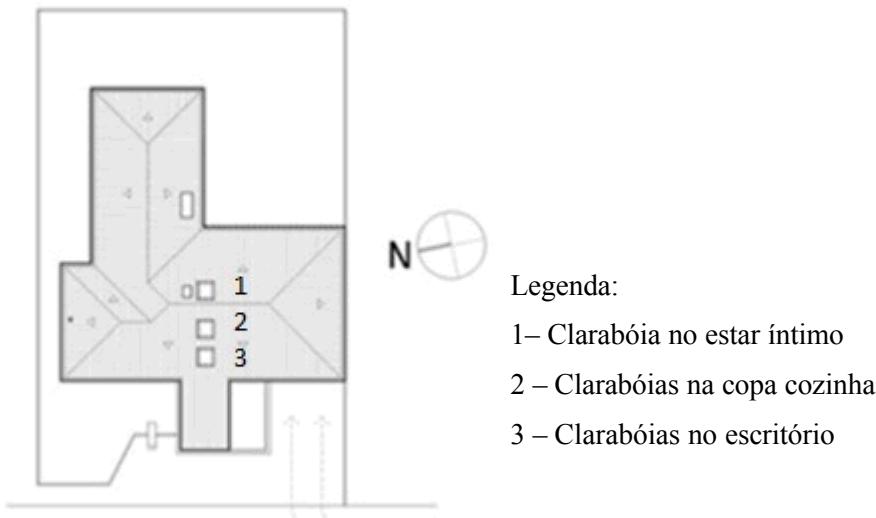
Planta de cobertura da edificação real, com a localização das três clarabóias
